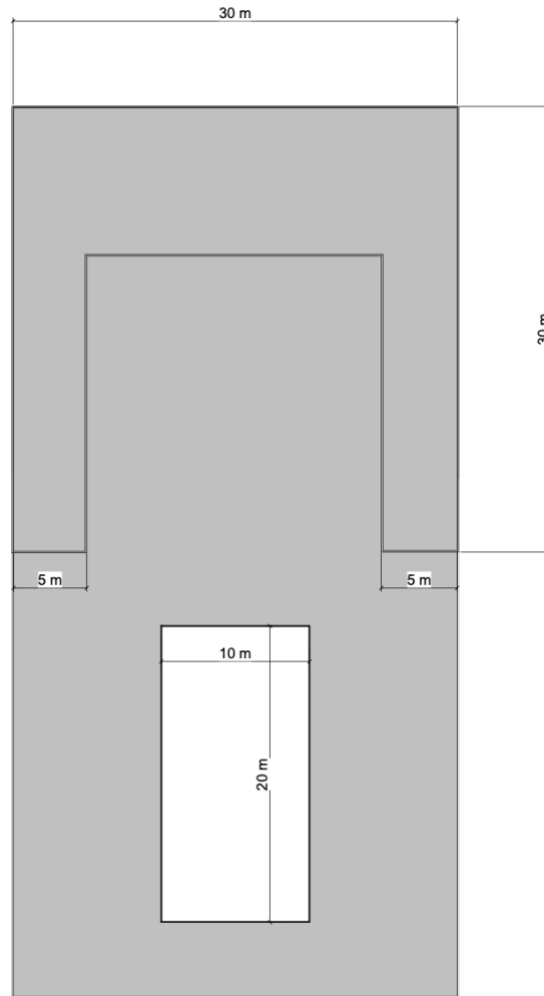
Vista superior de la primera planta de la solución volumétrica B. Fuente: Elaboración propia.
